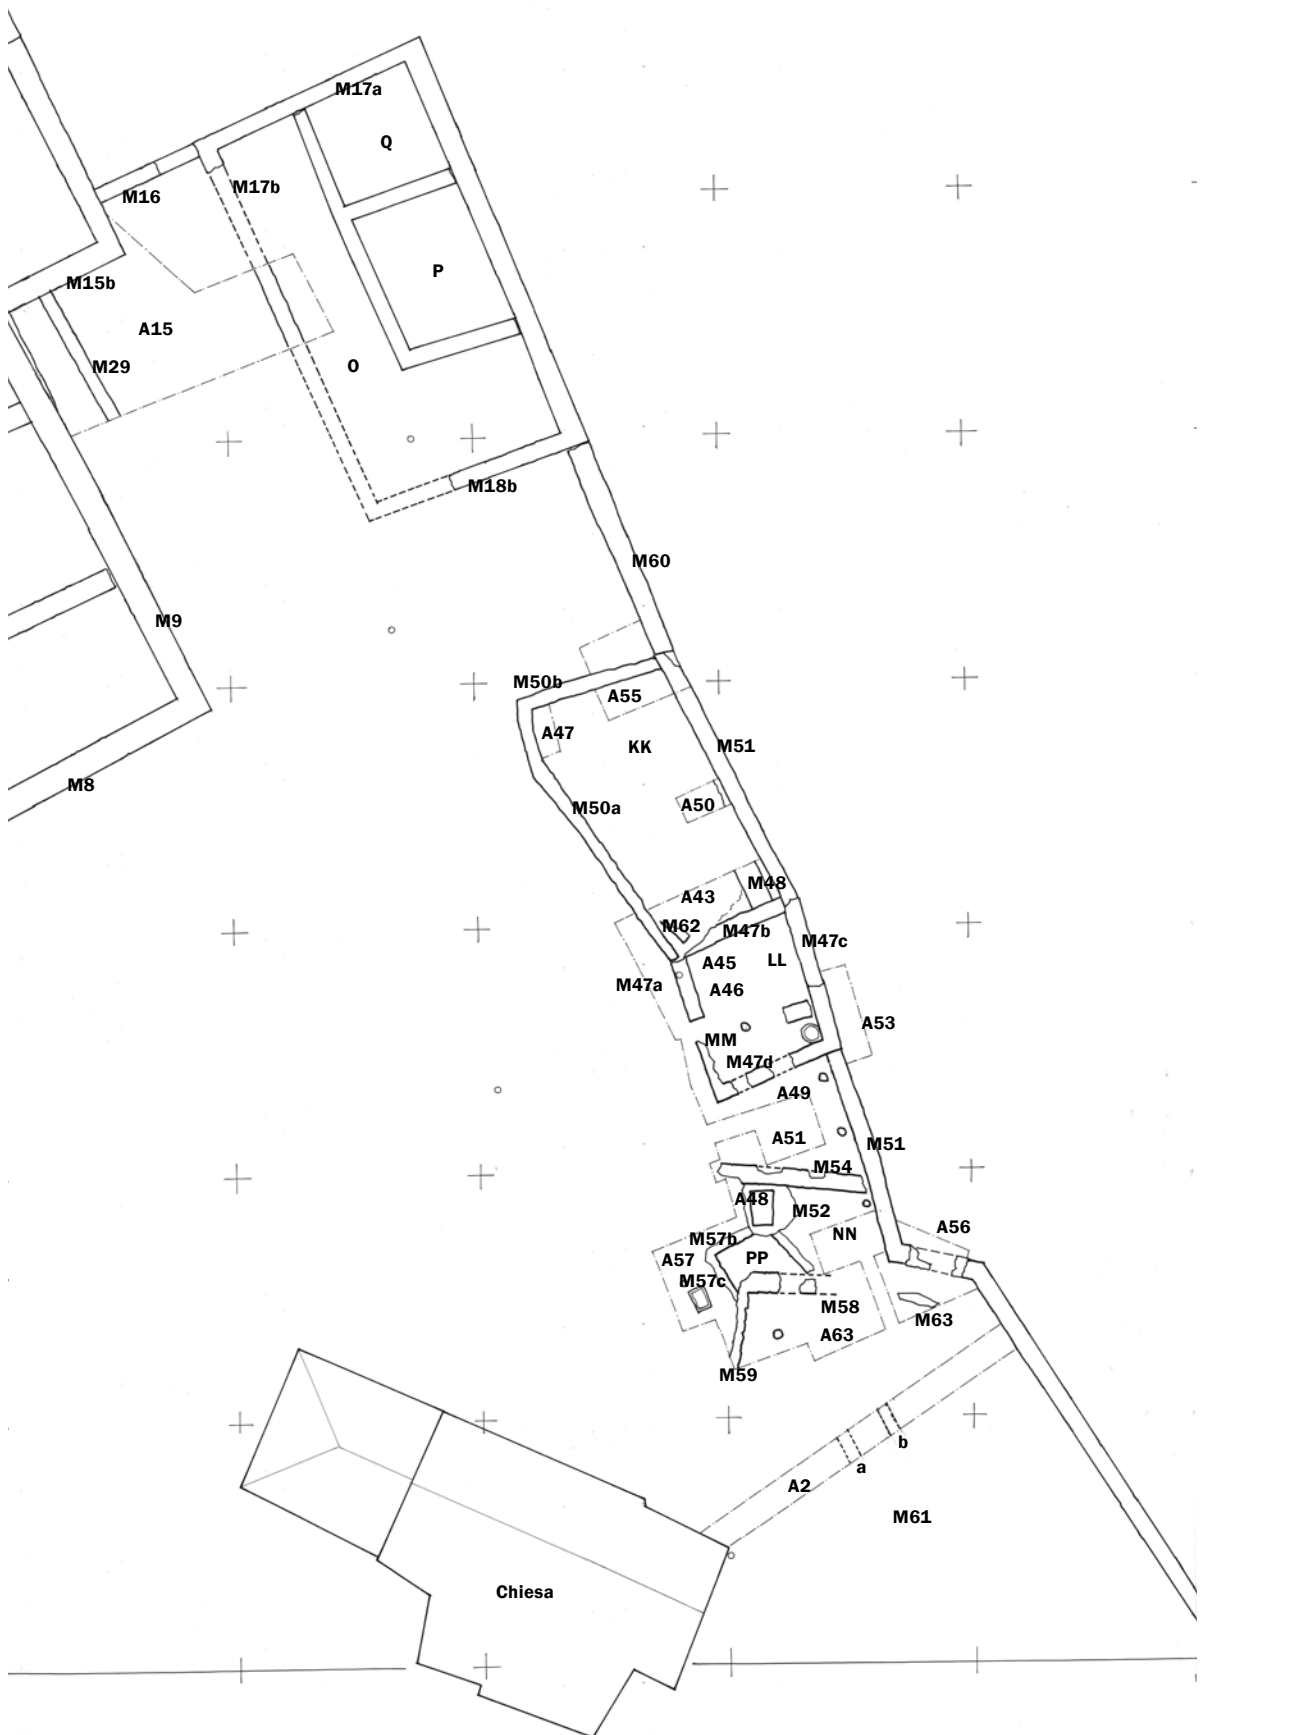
Planimetria della bassa corte, con numerazione dei muri e denominazione dei locali.
